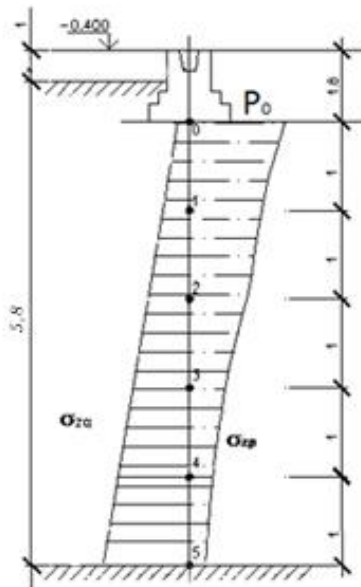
Схема расчета осадки фундамента на естественном основании
